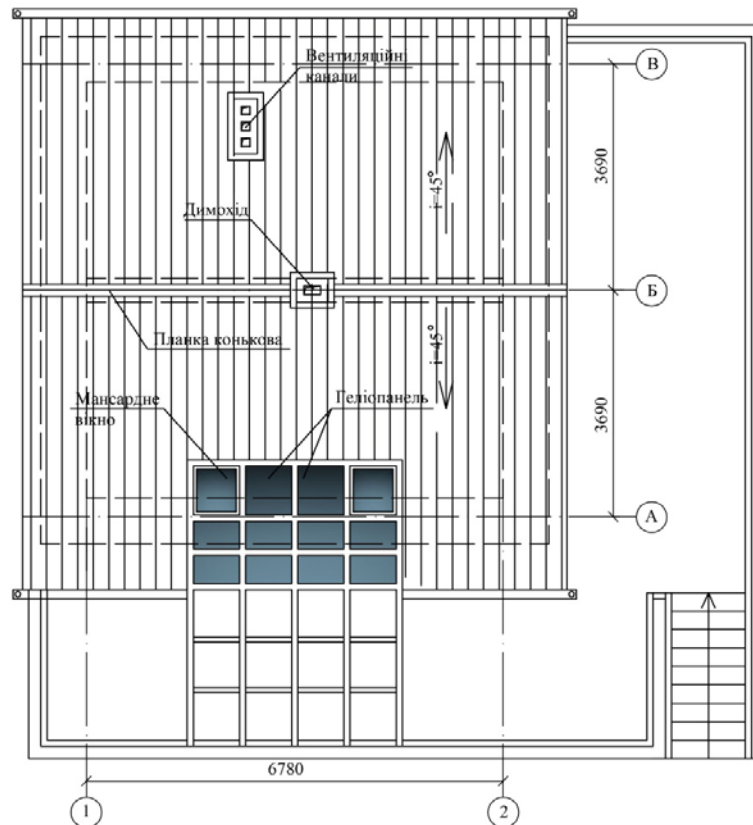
Екологічна будівля «Потрійний нуль». План покрівлі
